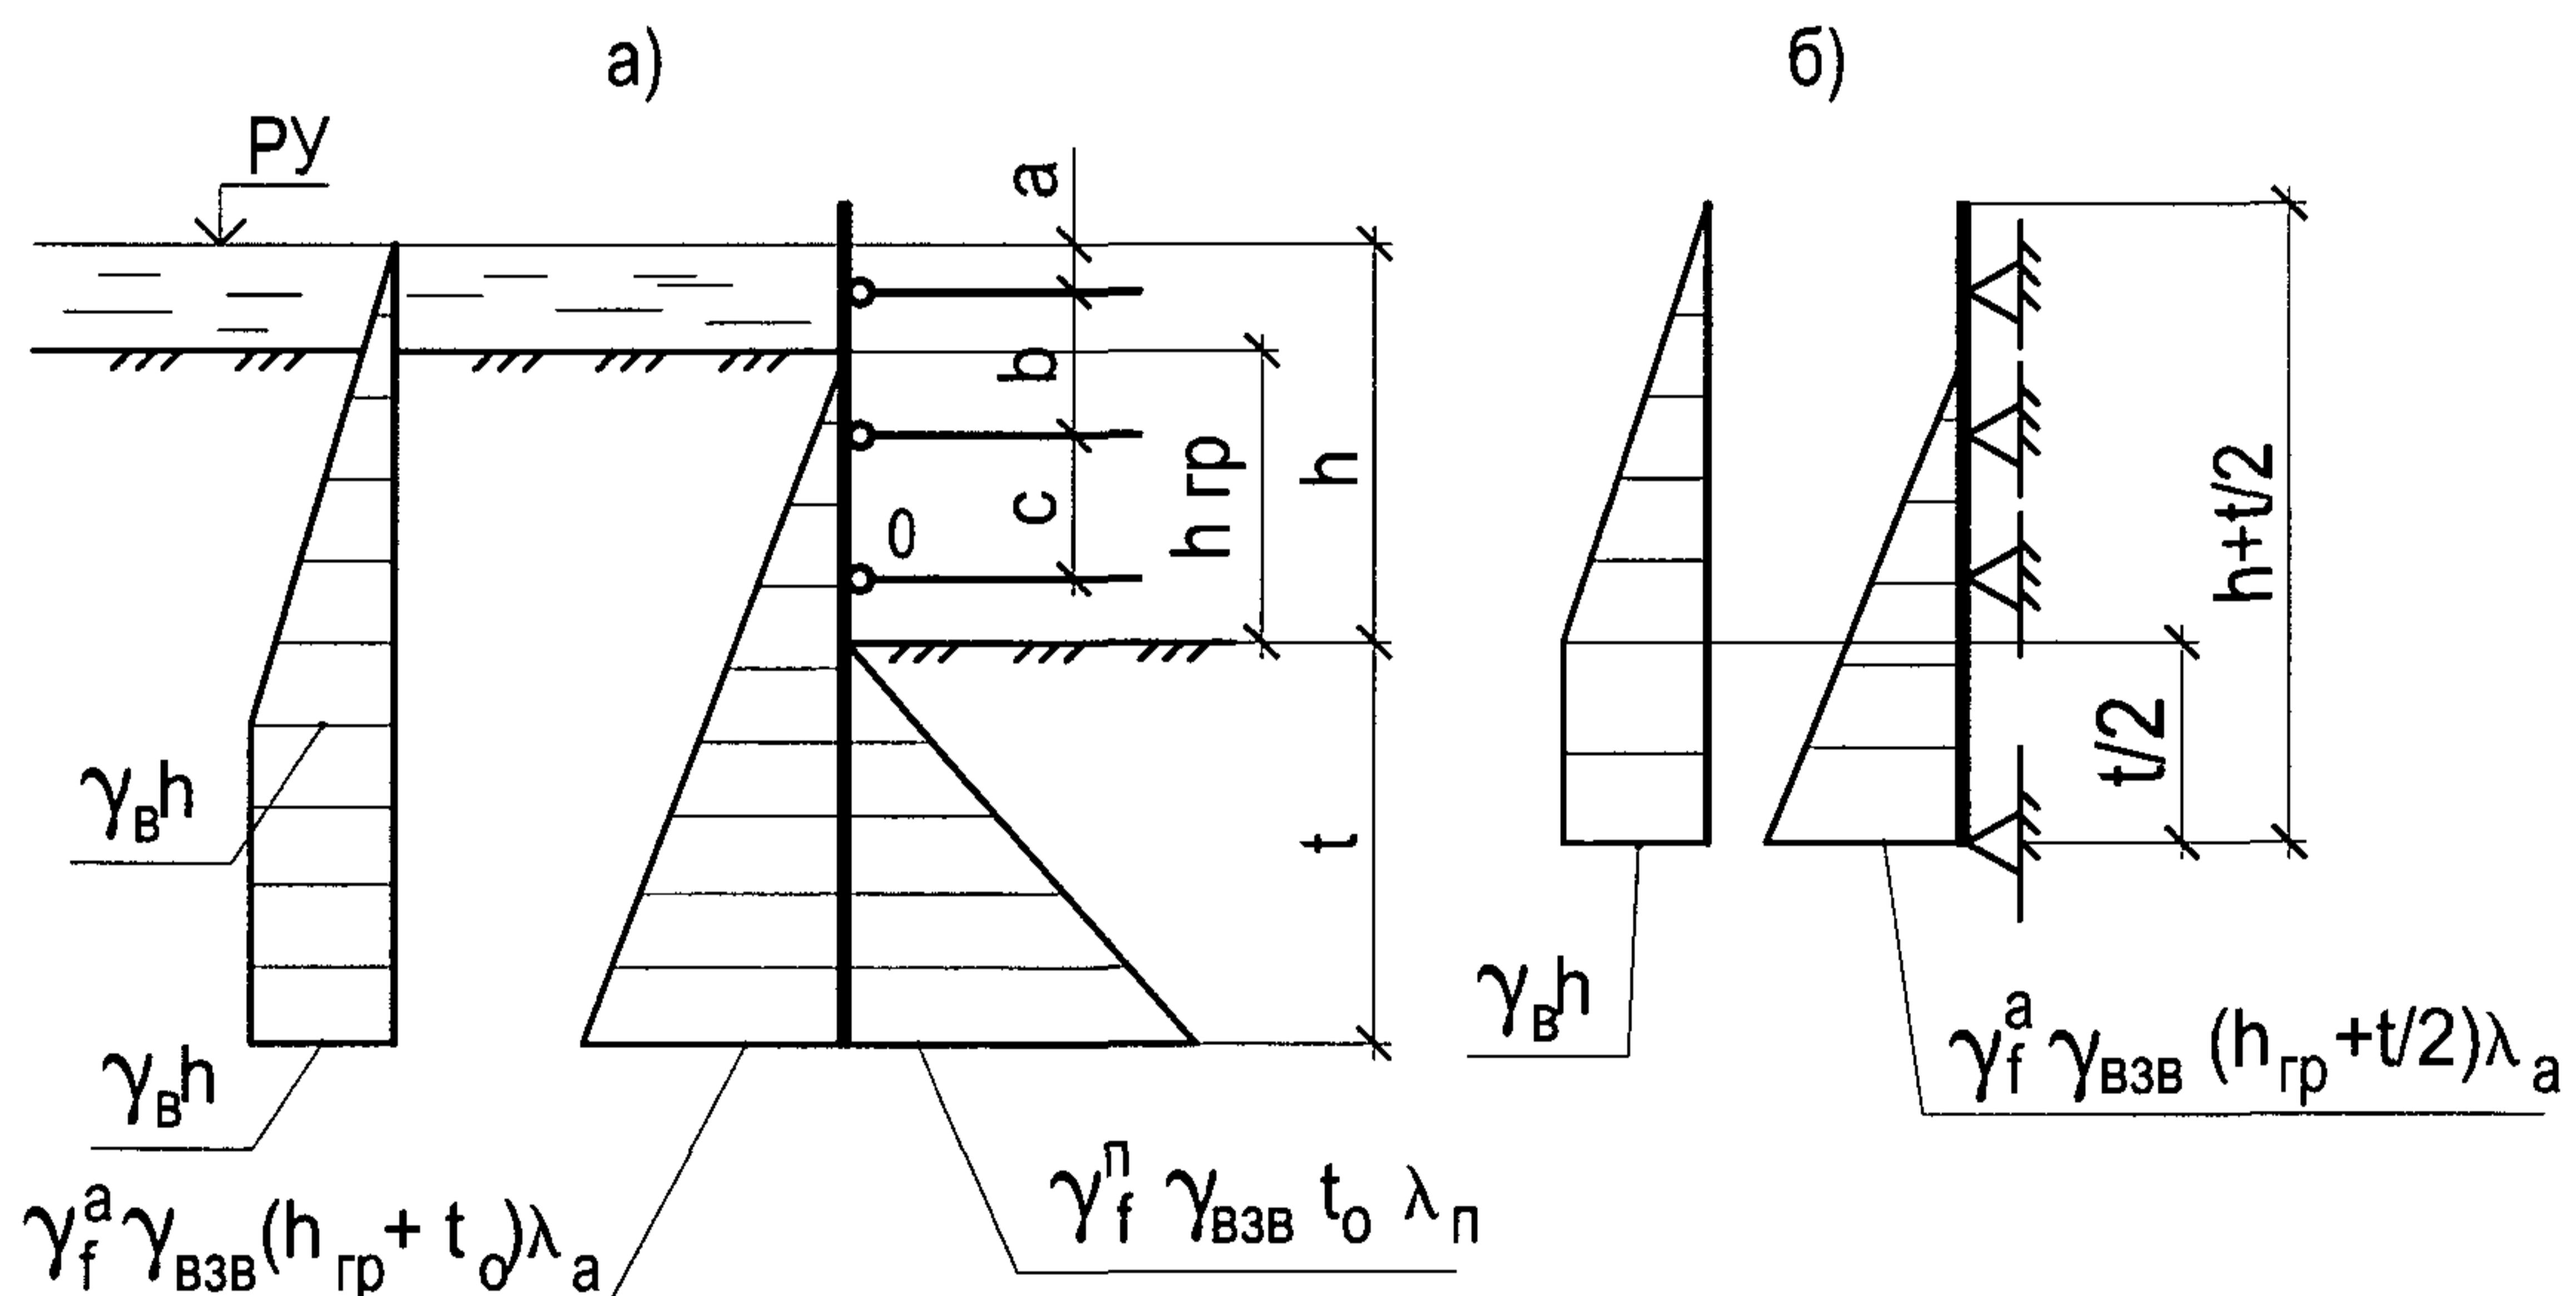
Схемы расчета шпунтовых ограждений
